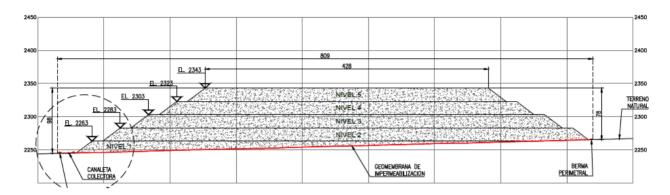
Sección transversal típica – Pila ROM Óxidos Esperanza Sur
